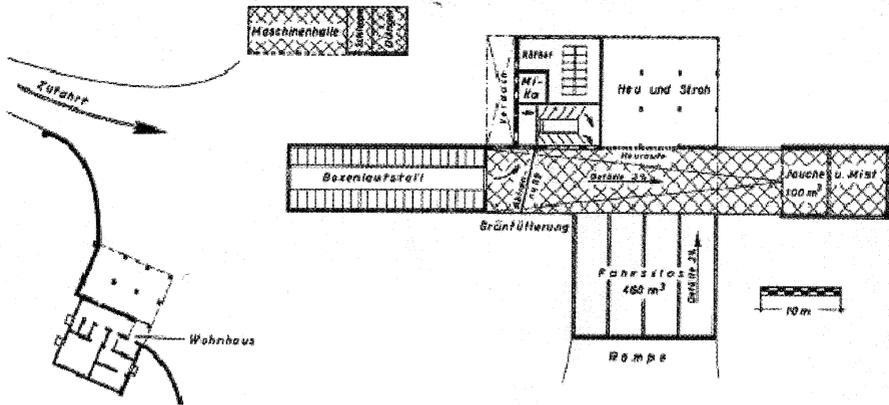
Grundriss des Frontladerhofes „Ernst“ in Utting am Ammersee
